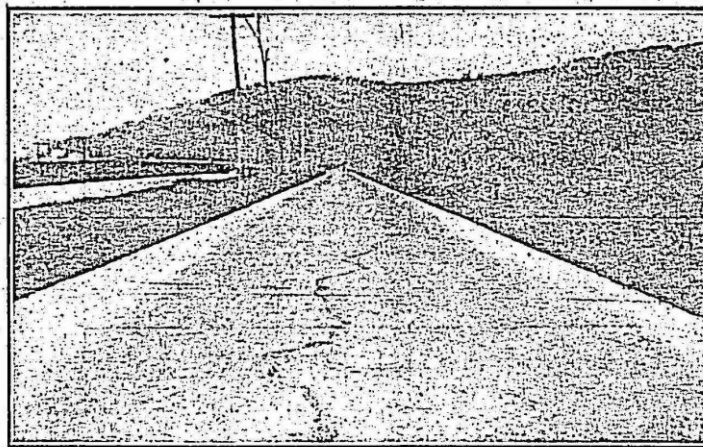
Fenda longitudinal typica num pavimento desprovido de junta central.
